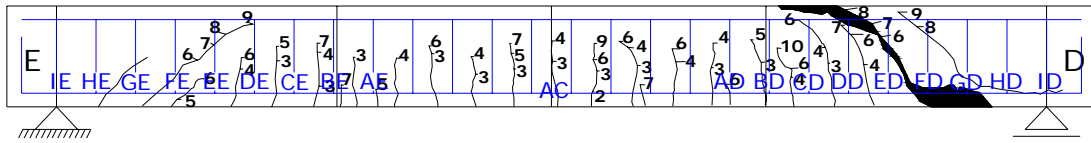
Padrão de fissuração e esquema da armadura transversal para a V90-2
